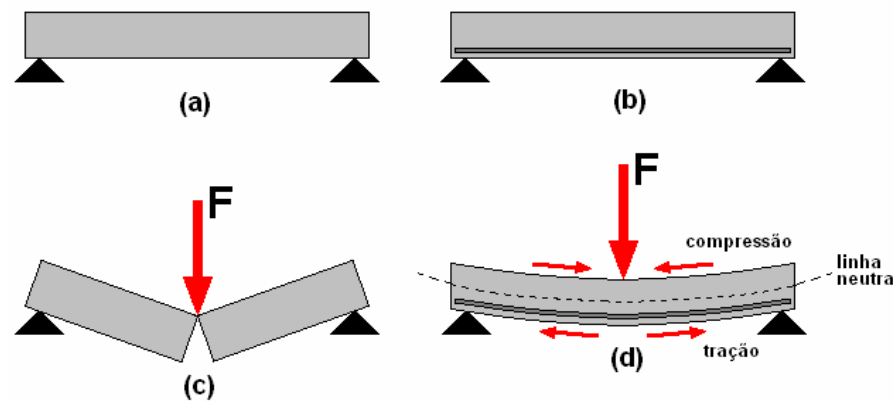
(a) Viga de concreto simples; (b) viga de concreto armado; (c) fratura da viga de concreto; (d) sistema composto do concreto armado funcionando.
